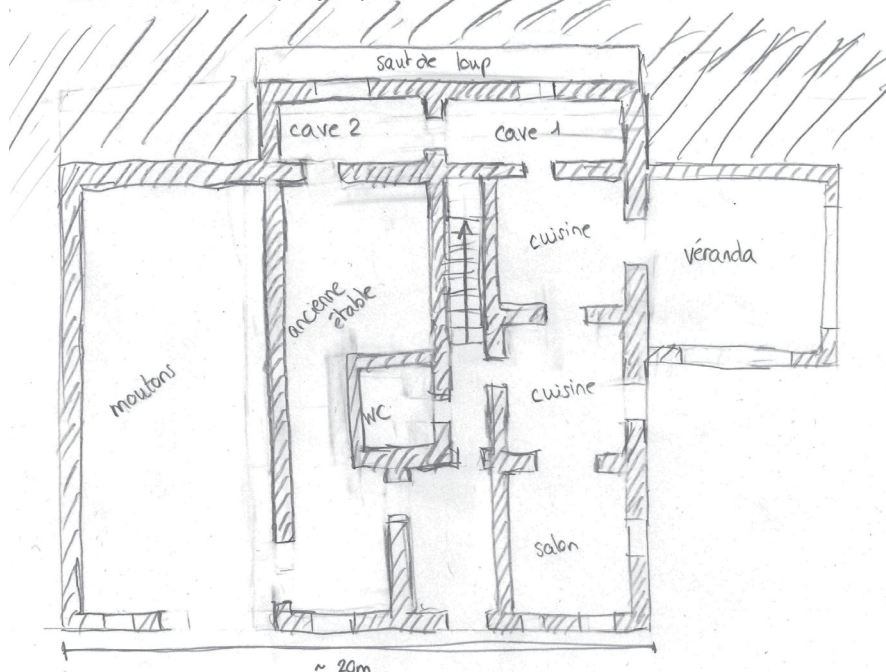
Croquis d'enquête, plan du rez-de-chaussée, Le Montois
